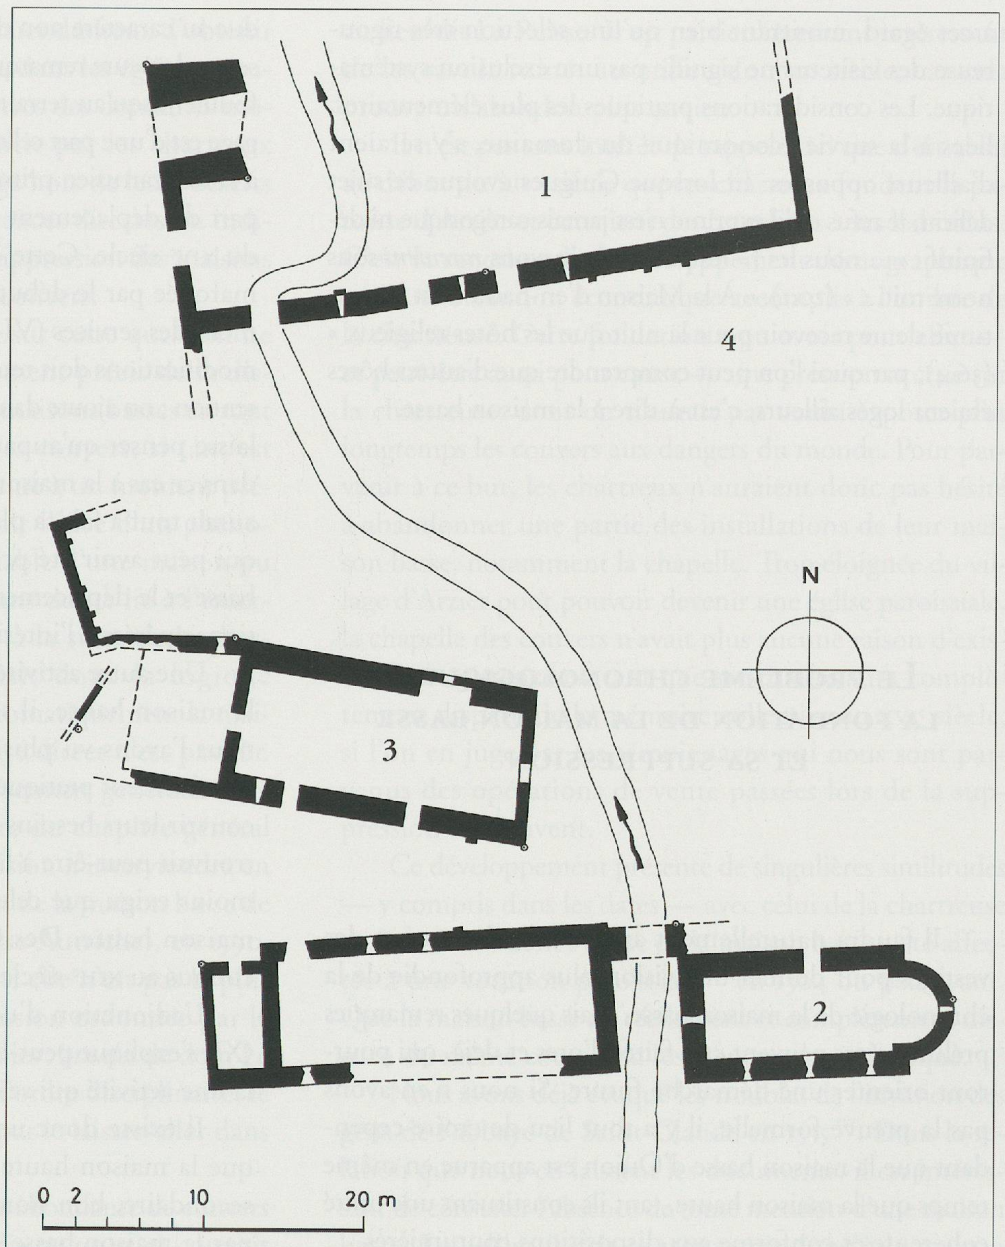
Plan de la maison basse de Montrieux, d'après R. Boyer.
